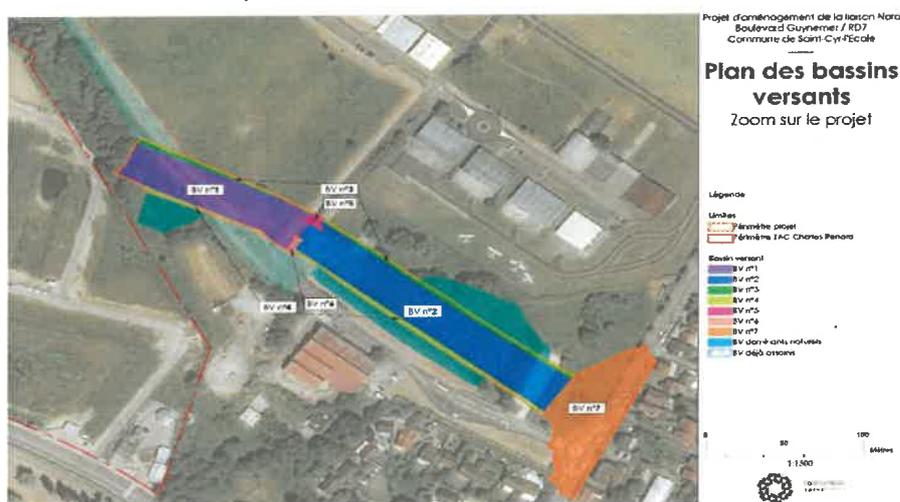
Plan des bassins versants du Boulevard Beltrame
